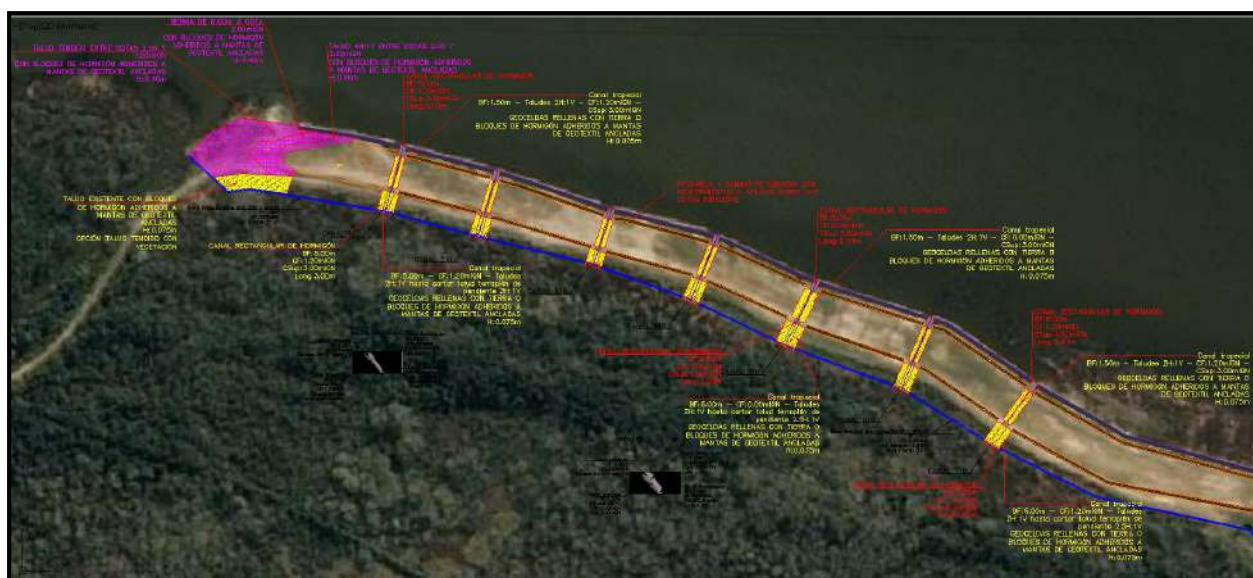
ubicación en planta de la protección con bloques de 0.075 m de alto (amarillo)
